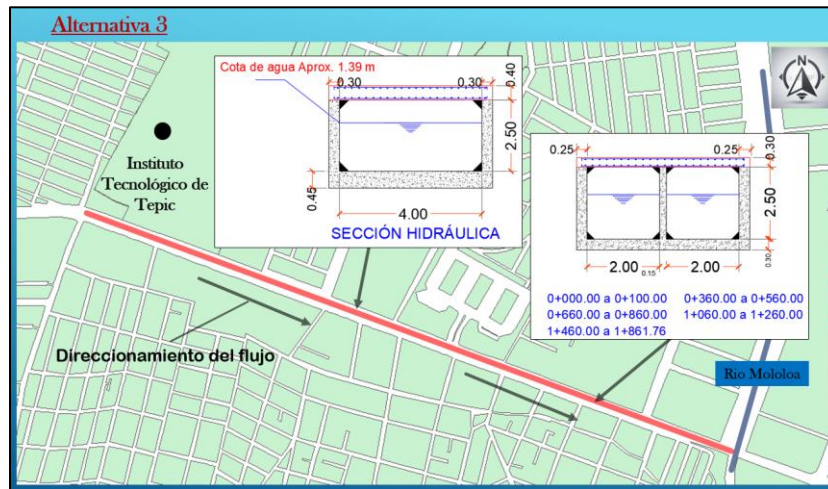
Resumen de red de distribución en planta y secciones hidráulicas de alternativa 3.
